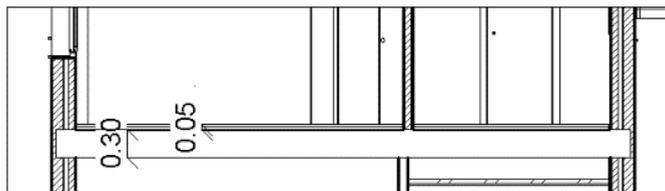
Sección suelo modificado. 2014. Elaboración propia TFG.
